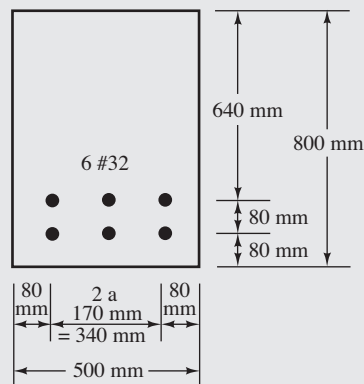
Sección transversal de la viga del ejemplo 4.7.
